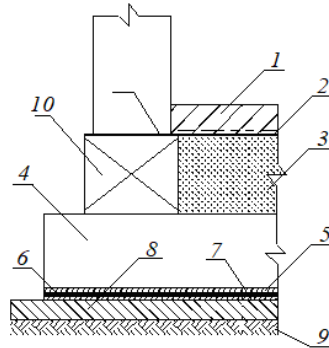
Сочетание фрагментированного и сплошного барьеров с мембраной: 1 — монолитный, армированный дорожной сеткой бетон; 2 — полимерная пленка; 3 — песчаная подсыпка; 4 — монолитный железобетон; 5 — защитный слой; 6 — рулонный гидроизоляционный материал; 7 — выравнивающая стяжка; 8 — подготовка из тощего бетона; 9 — уплотнённый грунт; 10 — фундаментный блок
